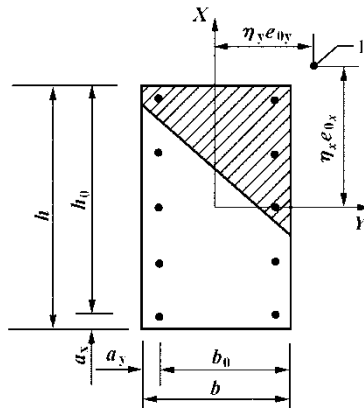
钢筋混凝土双向偏心受压构件截面图
